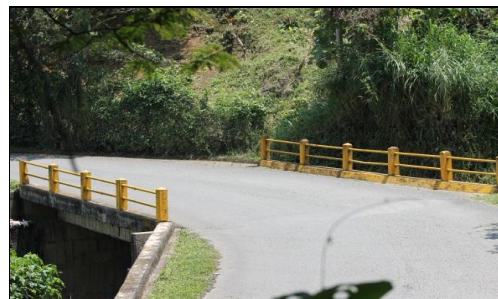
VISTA PANORAMICA TRANSVERSAL
